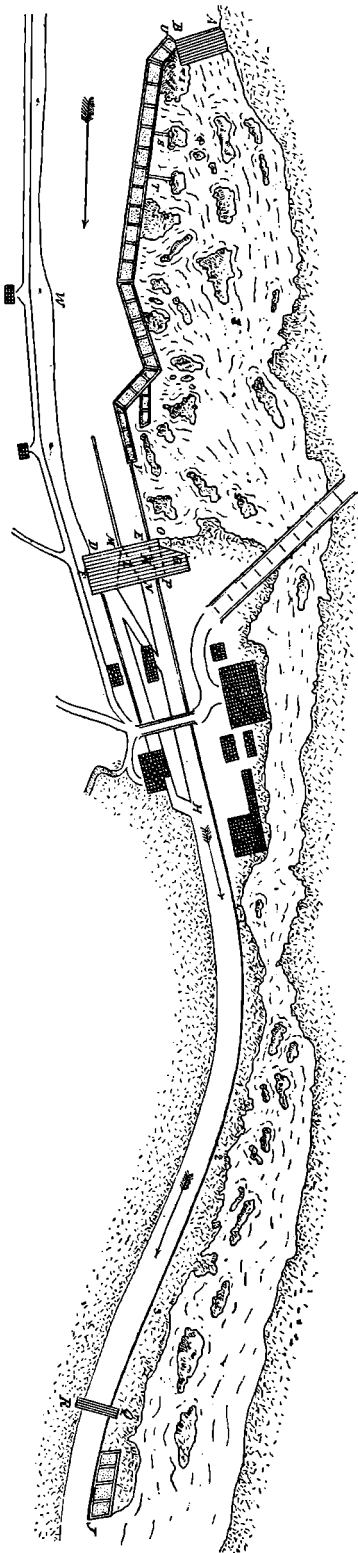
Plan des Wilden Lauffen. — Maßstab 1 : 1000.
